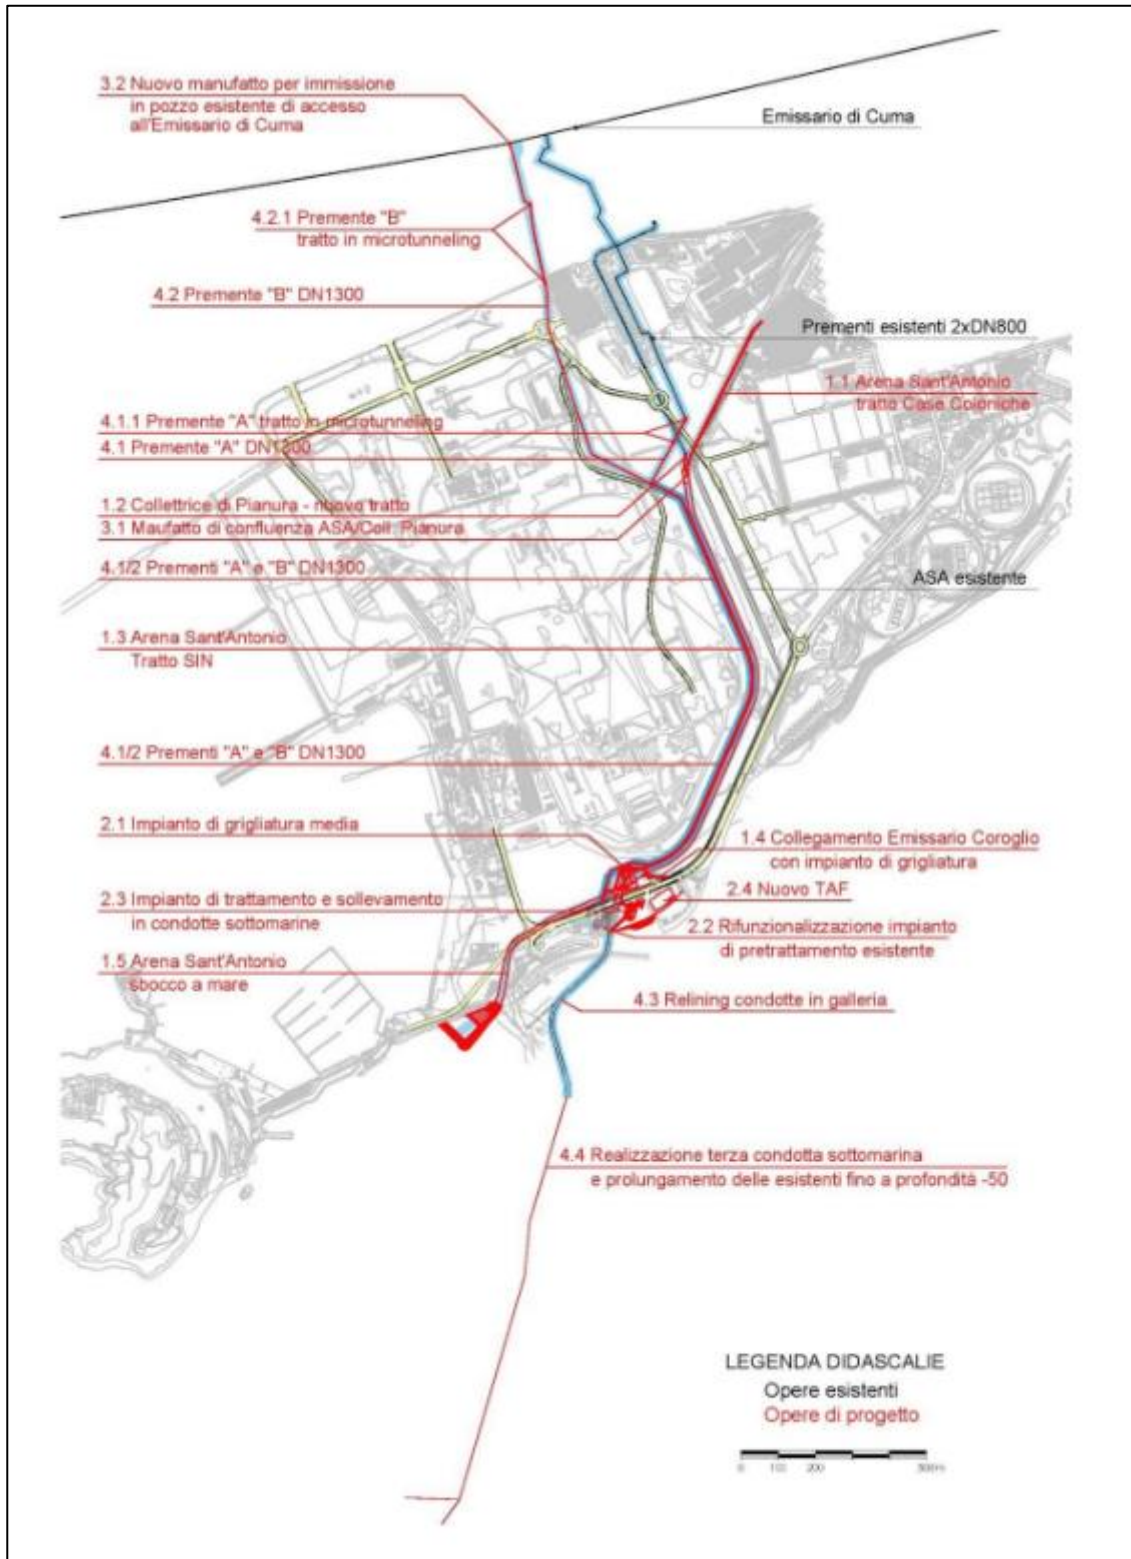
Planimetria schematica delle opere idrauliche di progetto
